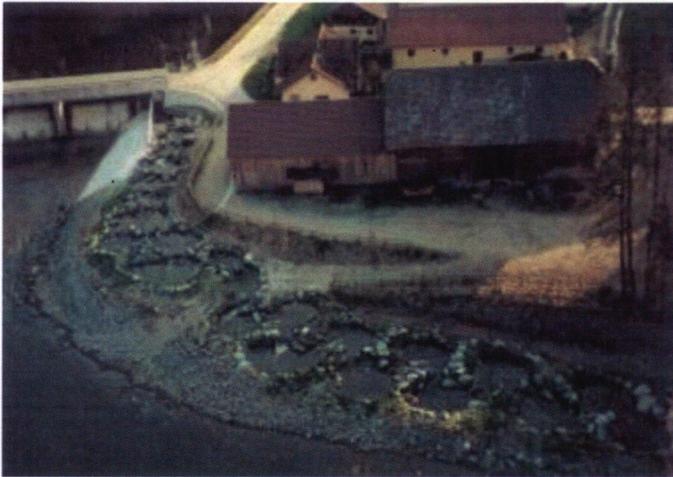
Umgehungsbach an der Ilz, Stadt Passau
